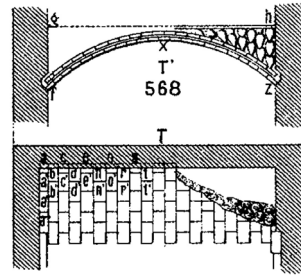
Processo construtivo numa abobadilha tipo alentejana (corte e planta) (Ger y Lobéz 1898)
